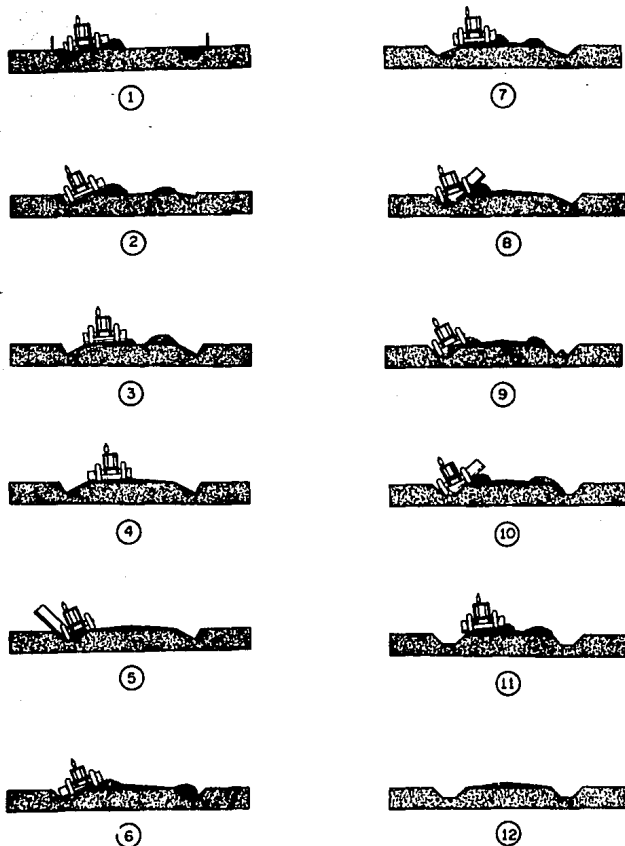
Motoconformadora realizando la construcción de caminos de acceso.
